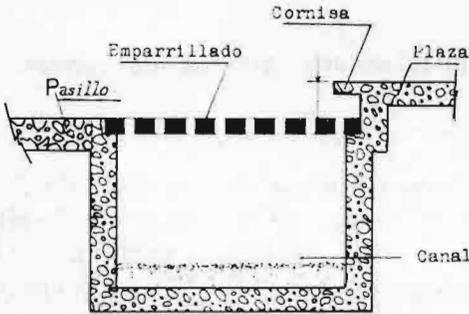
Esquema de emparrillado en plaza fija. La plaza está ligeramente elevada sobre el canal emparrillado.
